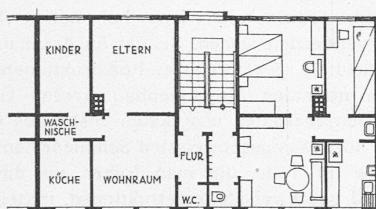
Grundriss des Holzskelett-Baublocks.
